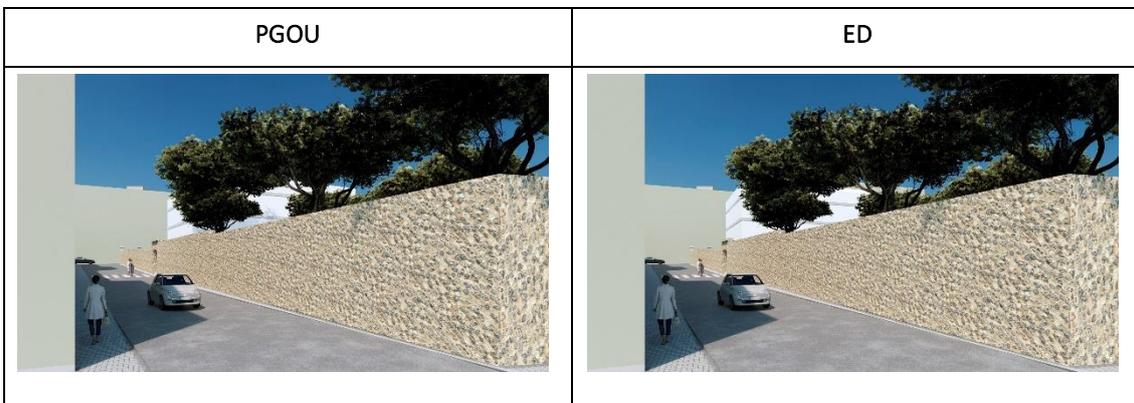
Vistas desde la C/ Burjassot, del PGOU vigente y de la propuesta del ED.
